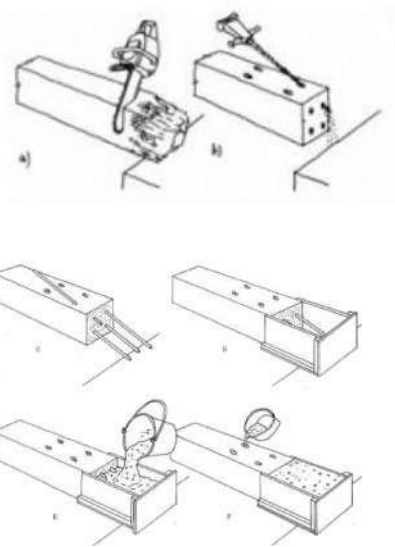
Refuerzo con sistema BETA. Maderayconstrucción.com
